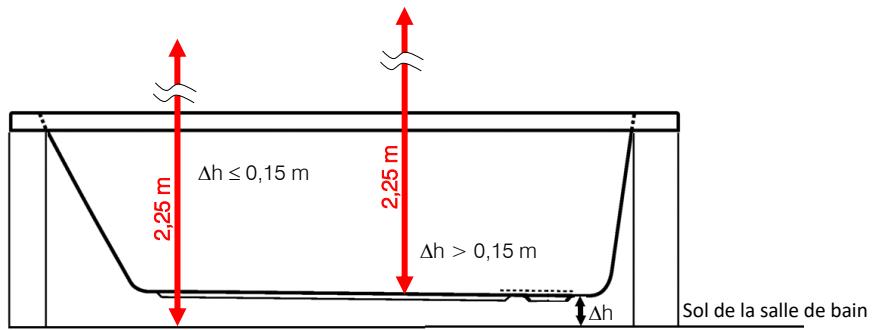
Détermination de la hauteur du plan horizontal supérieur
